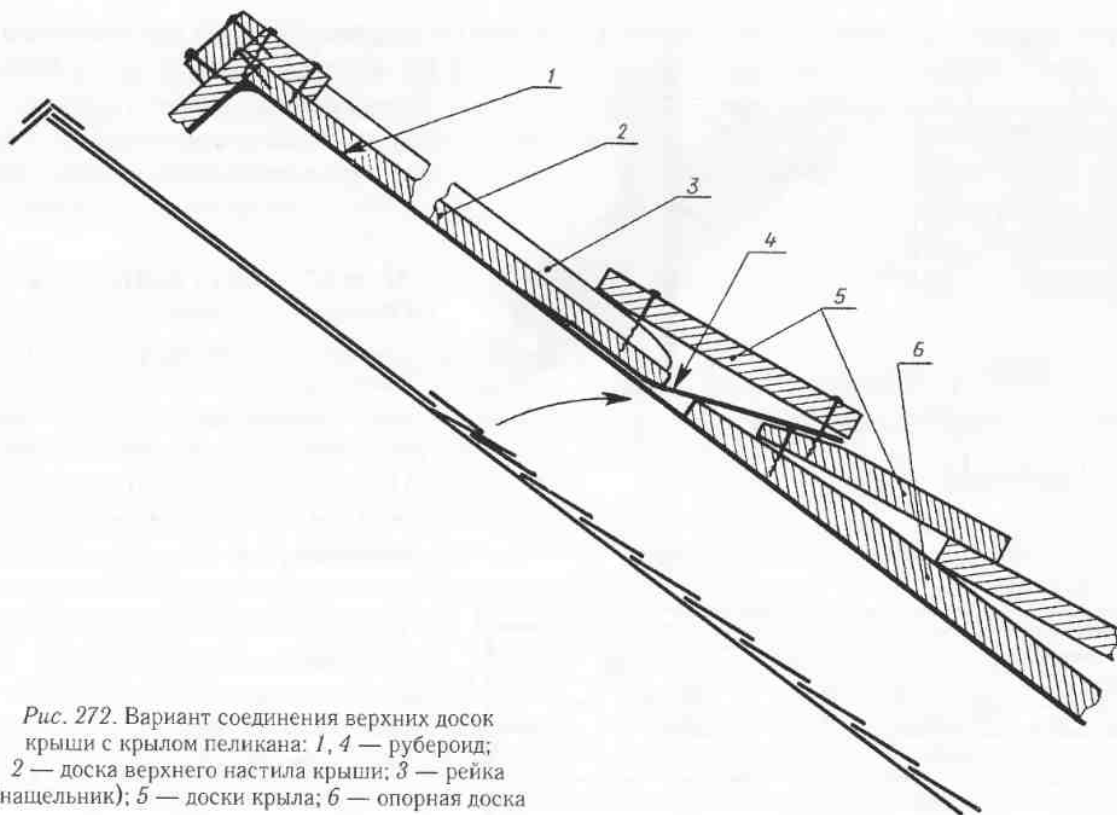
Вариант соединения верхних досок крыши с крылом пеликана: 1, 4 — рубероид; 2 — доска верхнего настила крыши; 3 — рейка (нащельник); 5 — доски крыла; 6 — опорная доска
